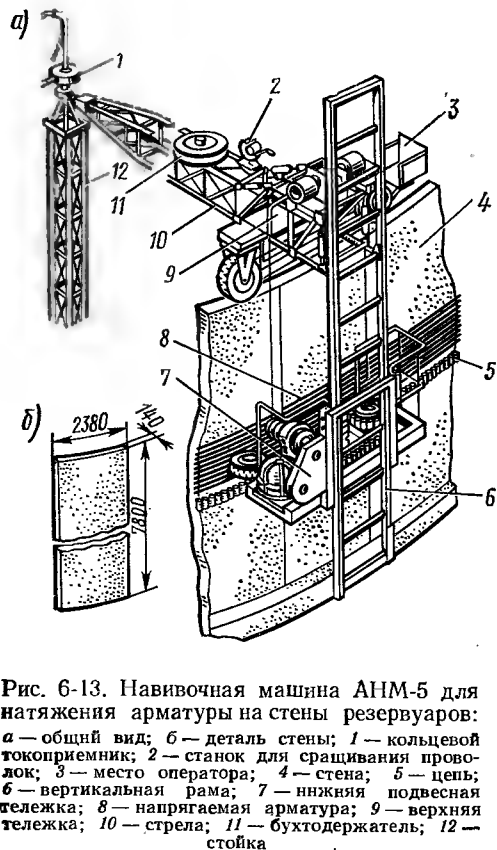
Навивочная машина АНМ-5 для натяжения арматуры на стены резервуаров: а — общий вид; б — деталь стены; 1 — кольцевой токоприемник; 2 — станок для срачивания проволоки; 3 — место оператора; 4 — стена; 5 — цепь; 6 — вертикальная рама; 7 — нижняя подвесная тележка; 8 — напрягаемая арматура; 9 — верхняя тележка; 10 — стрела; 11 — бухтодержатель; 12 — стойка
